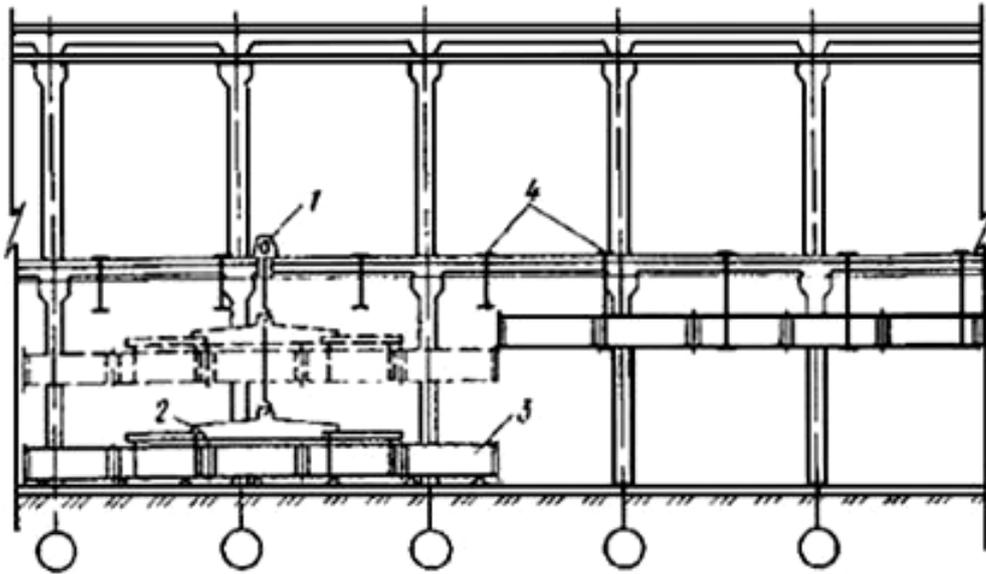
Схема организации рабочей зоны при монтаже горизонтальных воздуховодов в здании:
